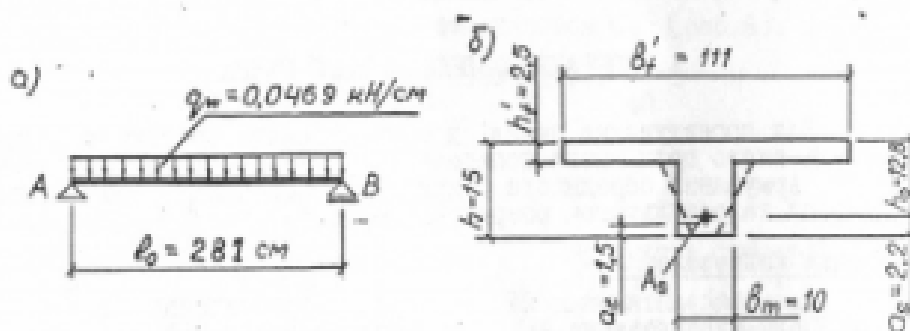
Розрахункова схема (а) та розрахунковий поперечний переріз поперечного ребра (б).
